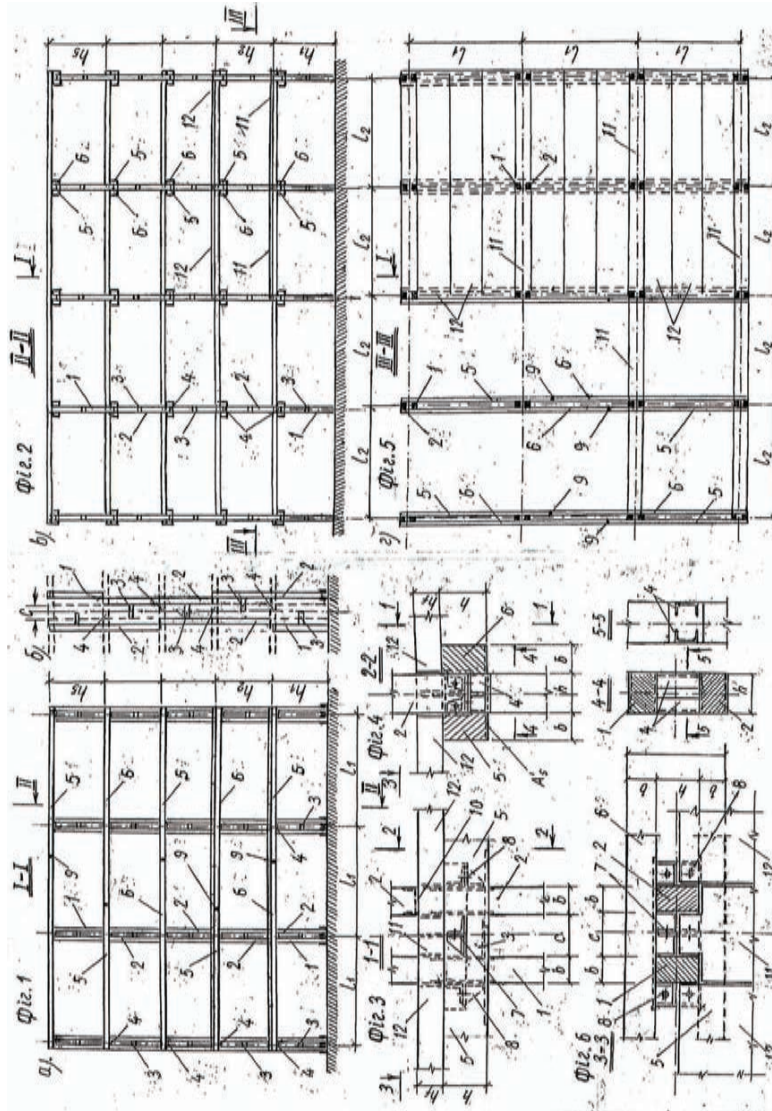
Збірний залізобетонний каркас багатоповерхових будинків з великорозмірних збірних елементів і змінною сіткою колон: а – поперечний розріз каркасу; б – схема монтажу двовіткових колон; в – поздовжній розріз; г – монтажний план каркасу і перекриття
